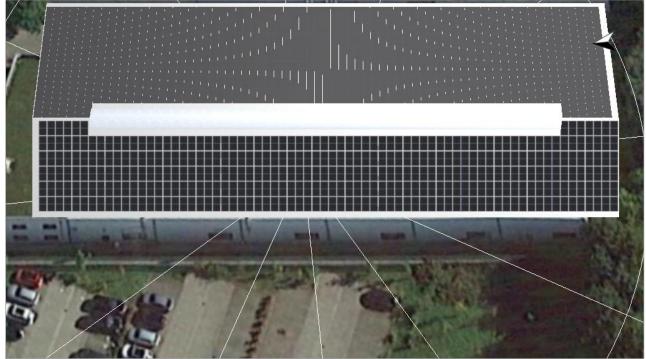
Module Area - Halle 3 osthaus & beckert GmbH 01-Fläche West
